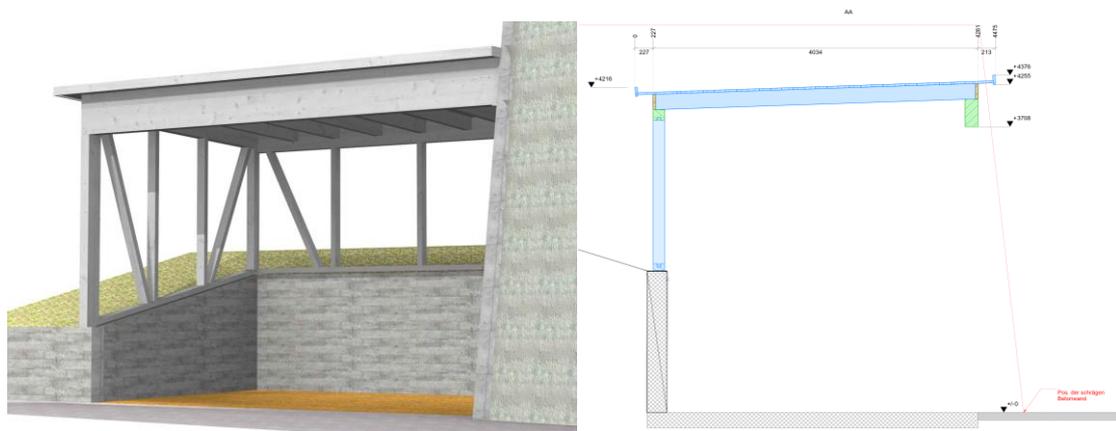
rechts: Ansicht Neuüberdachung (Vorabzug Stand 24. März 2023) Zimmerei Holzbau Meier + Brunner AG
